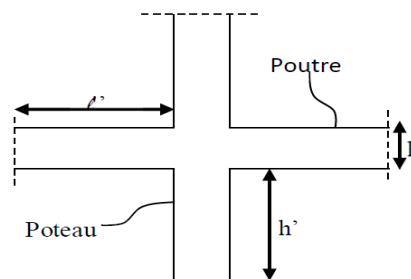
Zone nodale (nœud poutre-poteaux)
